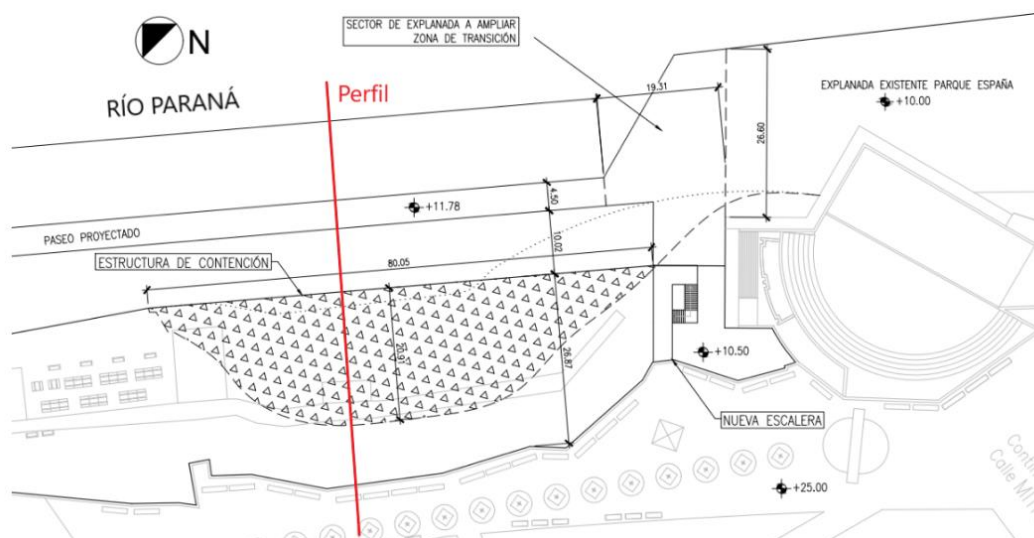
Esquema en planta de ubicación de perfil transversal.
